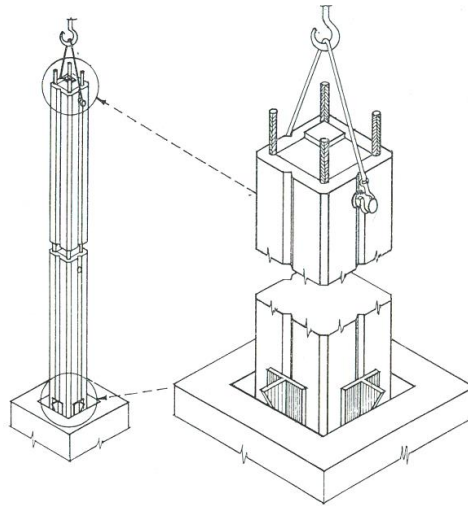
Схема монтажу і кріплення колон першого ярусу до фундаментів.
